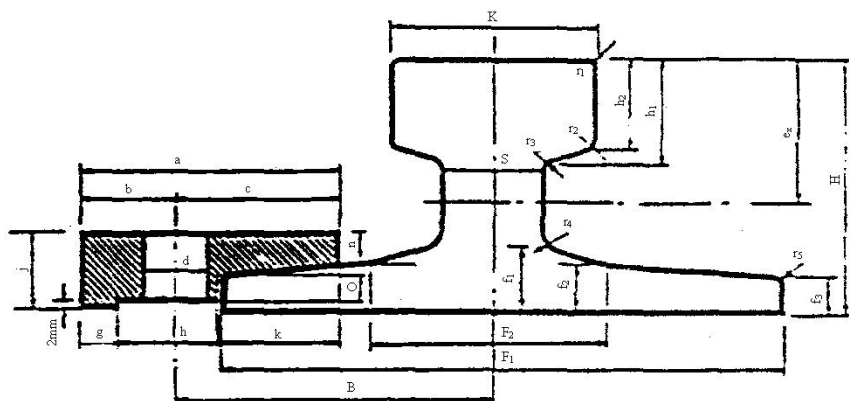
Dessin d'un rail et d'un crapaud.
